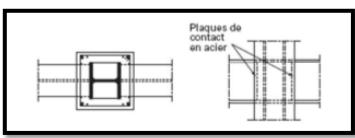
23 : assemblage d'un poteau mixte totalement enrobé de béton et d'une poutre en acier, source : Wikipédia
